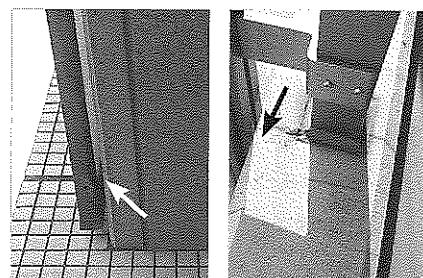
20mmの隙間(左)とガラスを外さないと補修できない鼻先のひび割れ(右)
